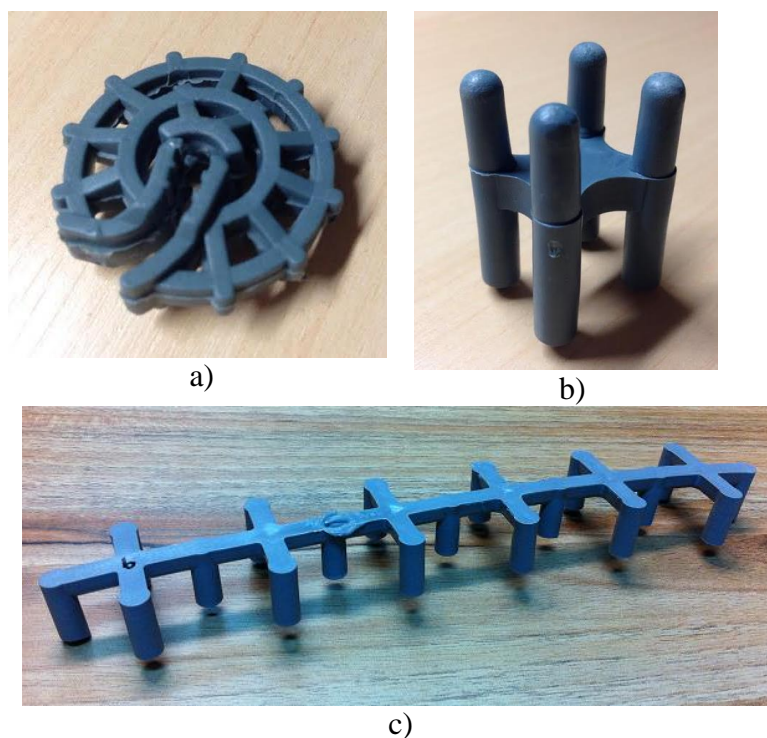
Espaçadores plásticos: a) tipo circular; b) tipo cadeirinha; c) tipo multiapoio.
